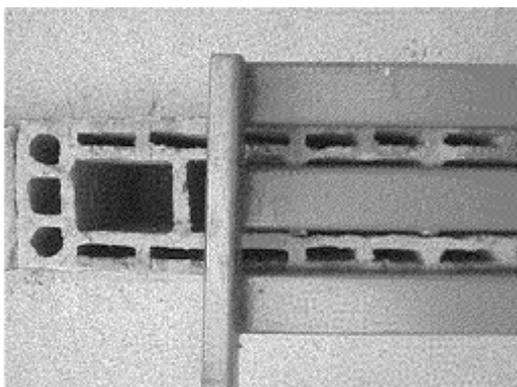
Vista em planta do gabarito p/ assentamento de argamassa sobre bloco
